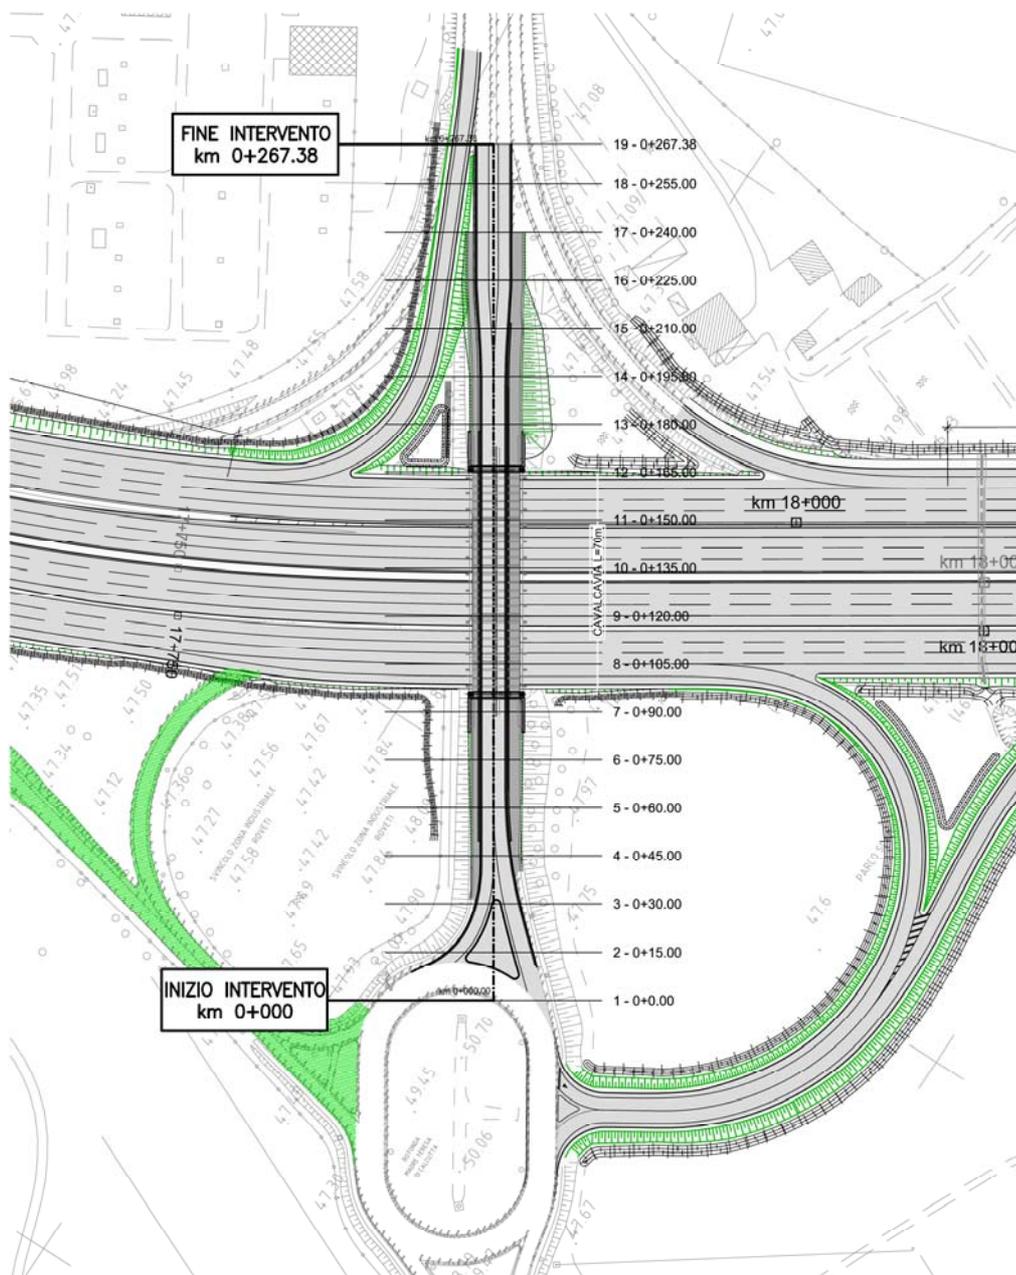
Stralcio planimetrico di via Cristoforo Colombo
